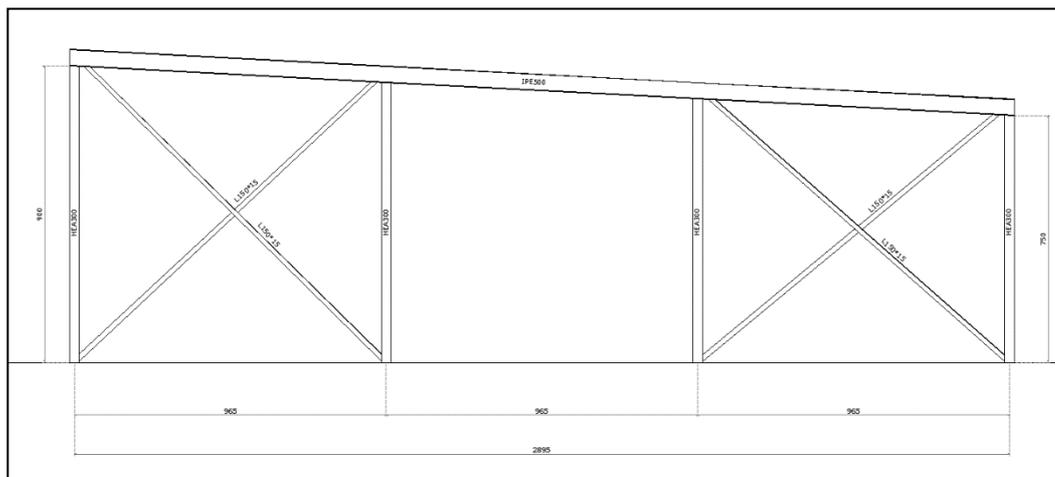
Prospetto struttura pensilina di copertura della baia di carico
